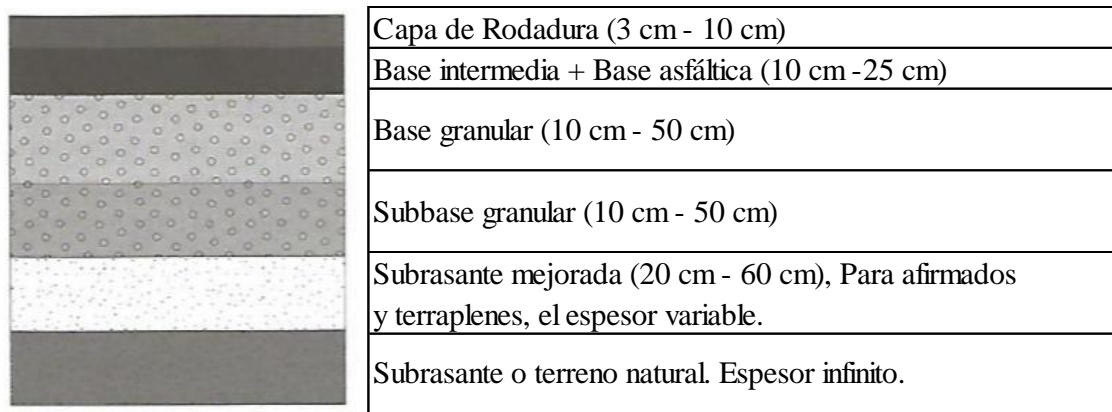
Perfil típico de una estructura de pavimento flexible
